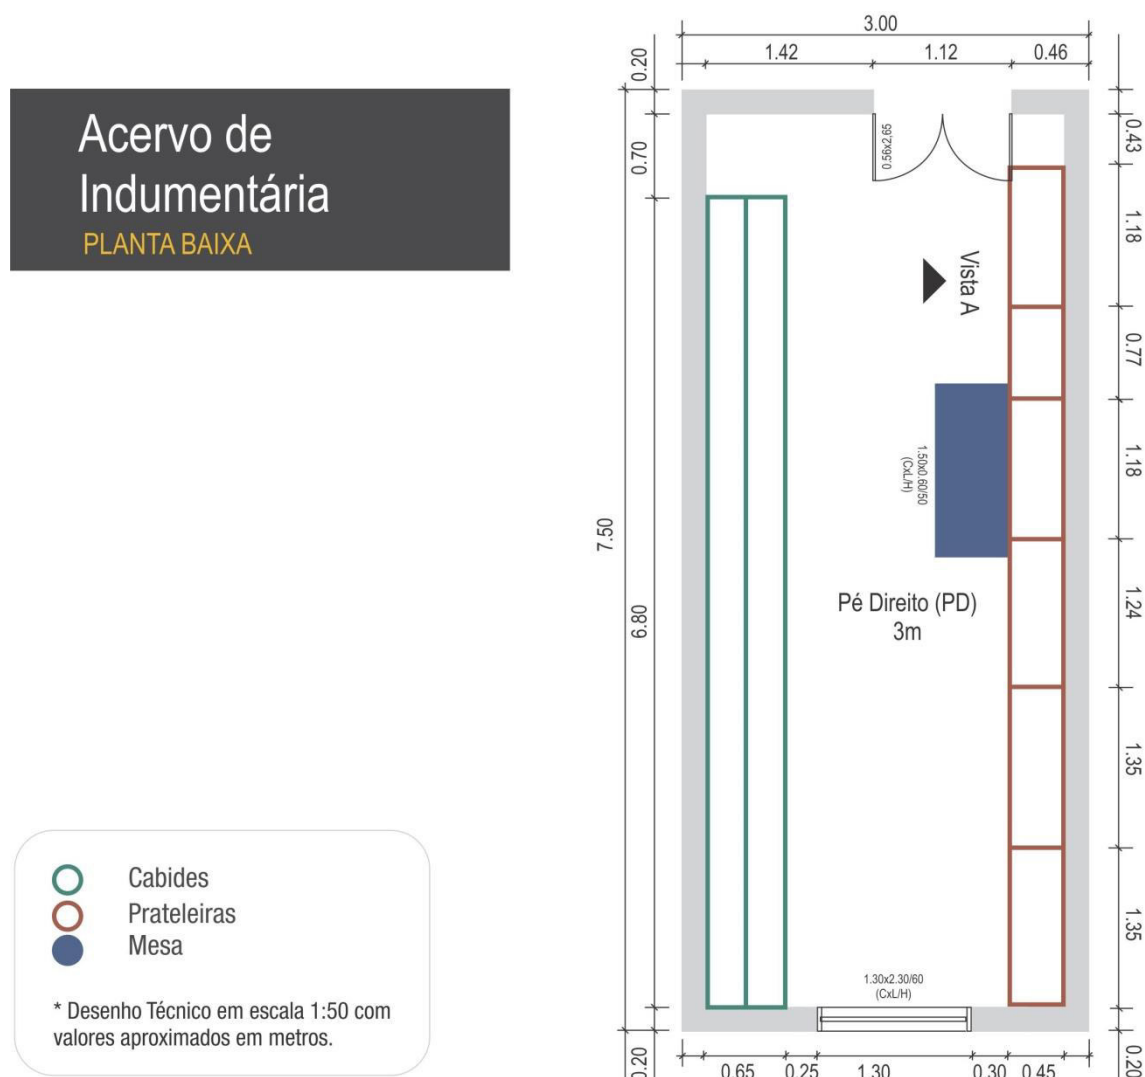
Planta baixa do Acervo de Indumentária. Elaborado por: A autora (15.10.2015).
